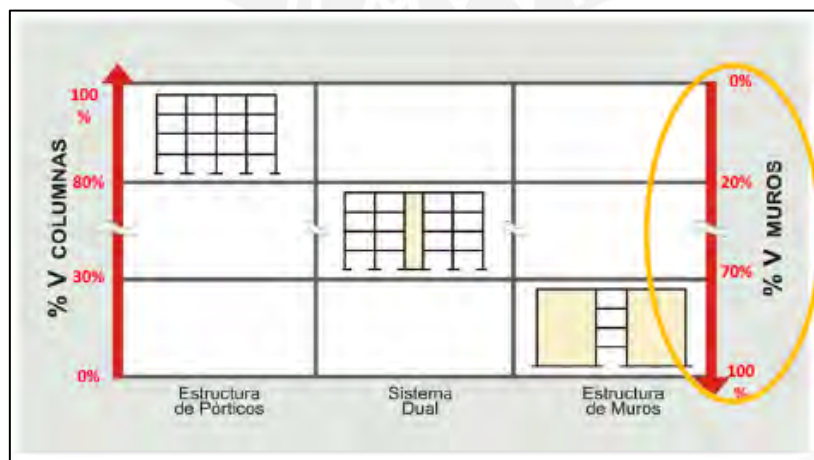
Clasificación de estructuras de concreto armado basado en la cortante en la base.
